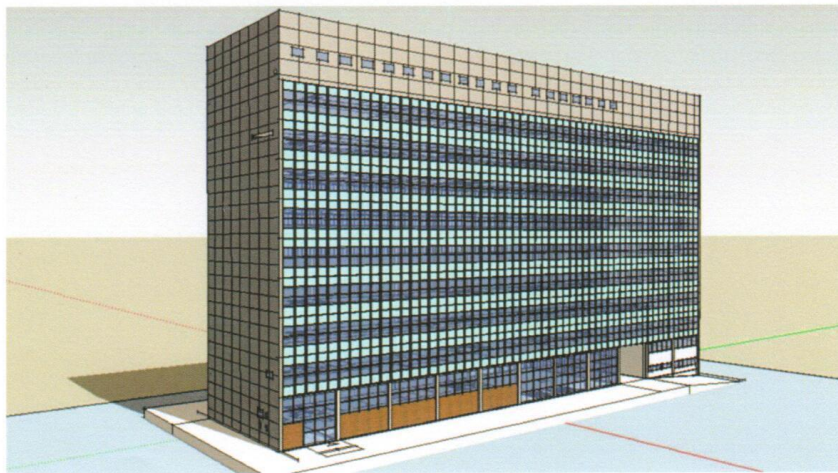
PERSPECTIVA - Fachadas Sul e Leste
